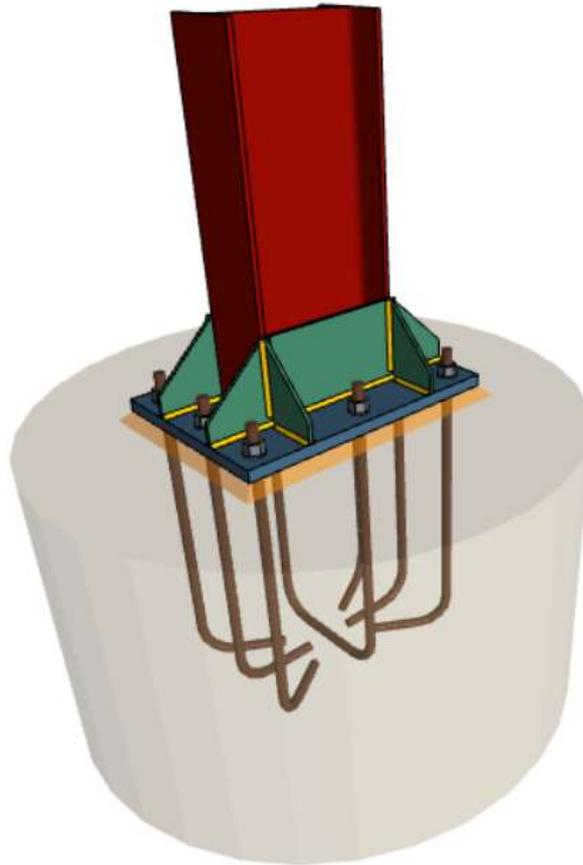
unión de pórticos de fachada frontal a cimentación
